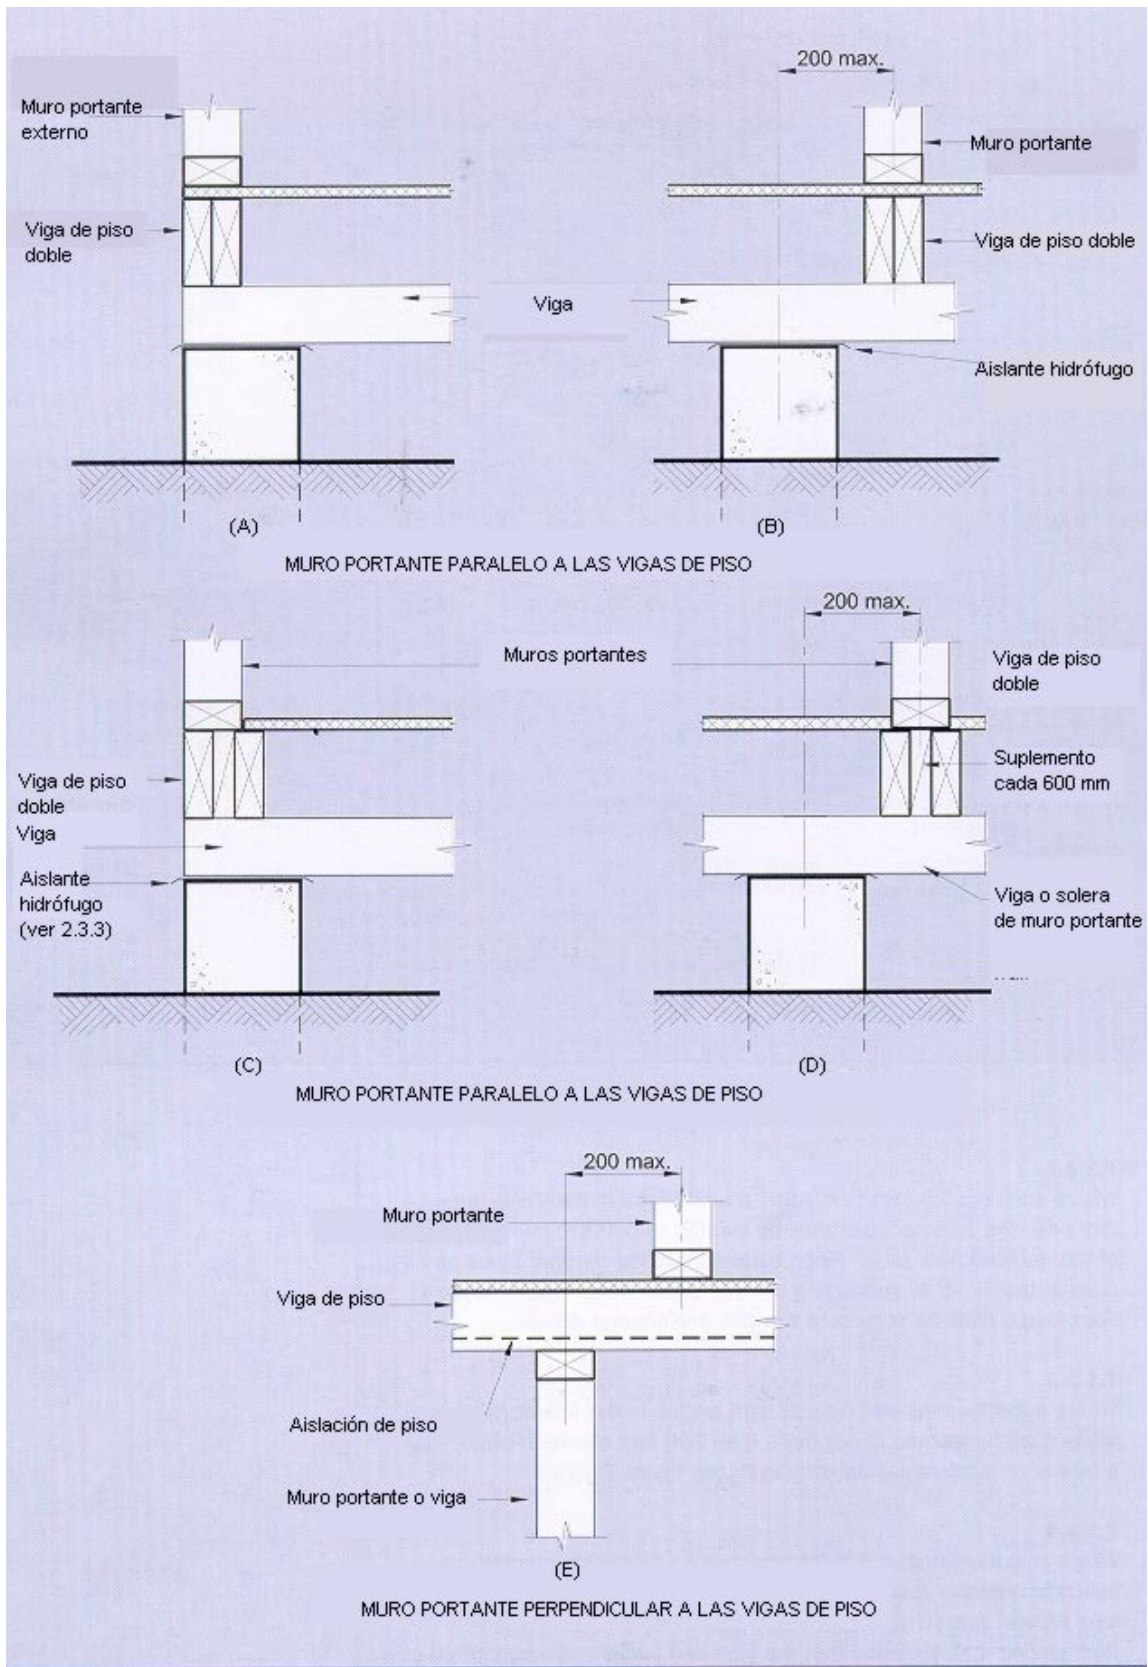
Apoyo de las vigas de piso bajo muros portantes (ver 7.1.3)
